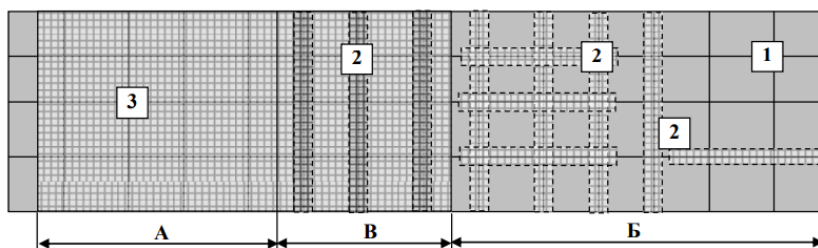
Схемы укладки геосетки. А – сплошная; Б – локальная (участковая); В – комбинированная; 1 – “старое” покрытие с трещинами; 2 – нахлест; 3 – полотно геосетки
